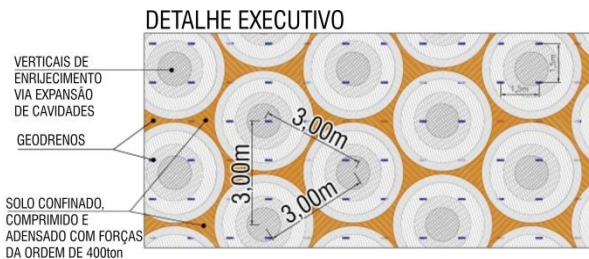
Detalhamento básico do enrijecimento do solo na Zona Portuária, com CPR Grouting.
